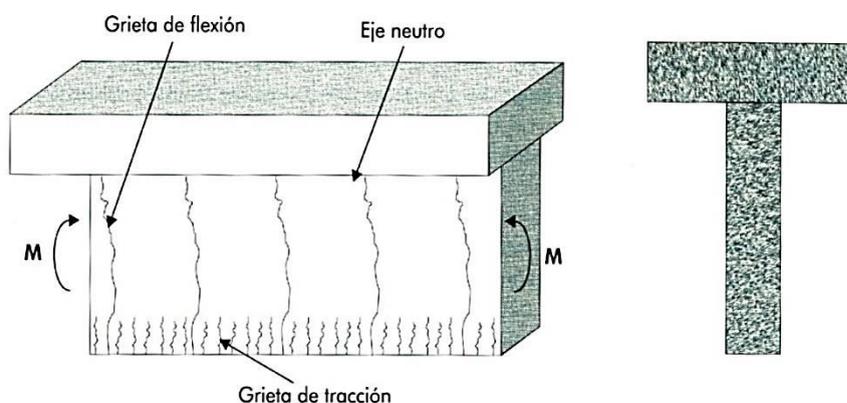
27 GRIETAS POR FLEXIÓN Y TRACCIÓN DE UN ELEMENTO SOMETIDO A ESFUERZOS DE FLEXIÓN.
